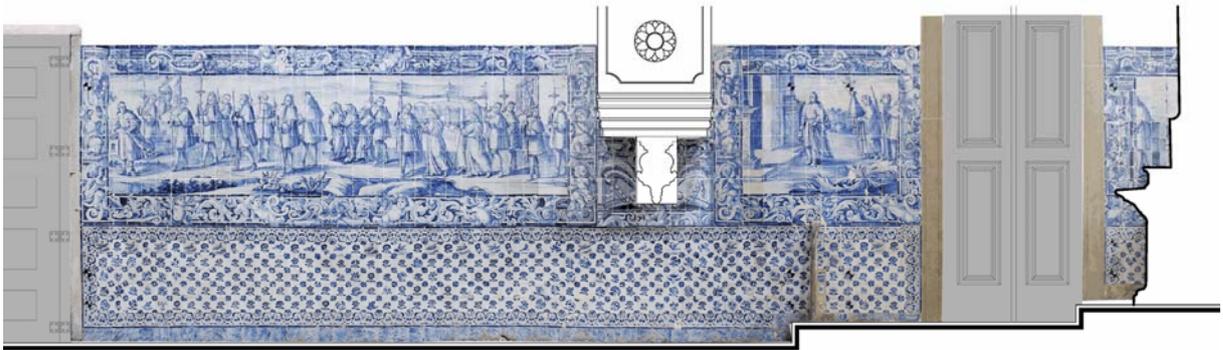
Igreja da Misericórdia - Exemplo de levantamento com ortofoto
